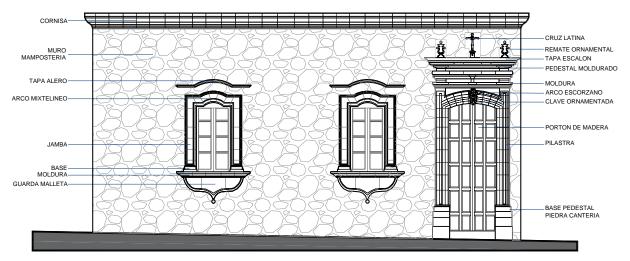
Croquis de la fachada del inmueble la Providencia de los Ates
